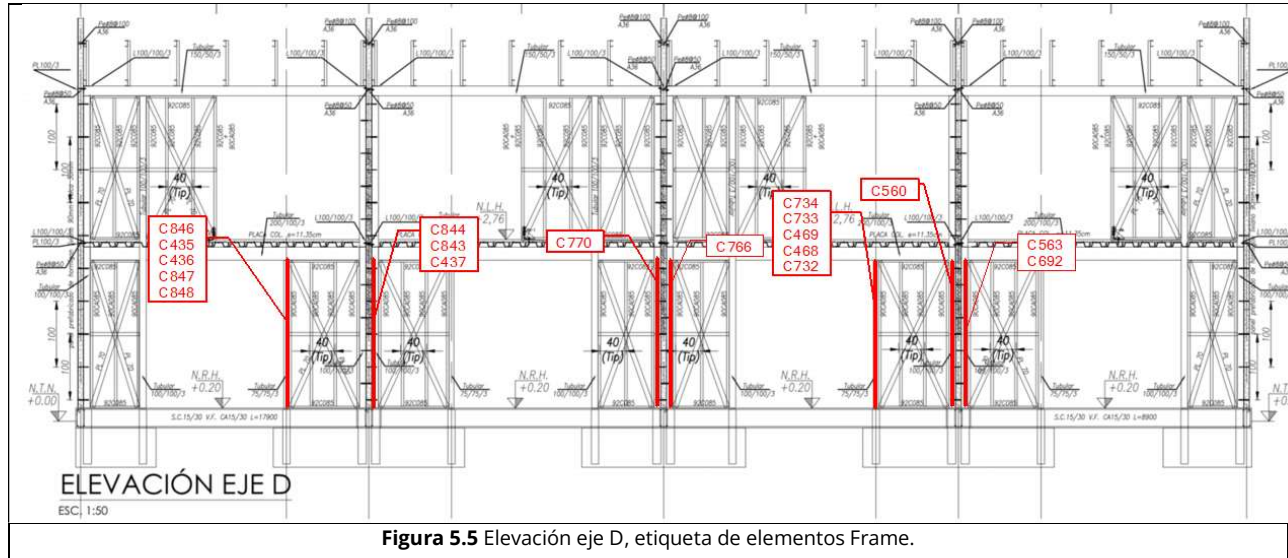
Elevación eje D, etiqueta de elementos Frame.
